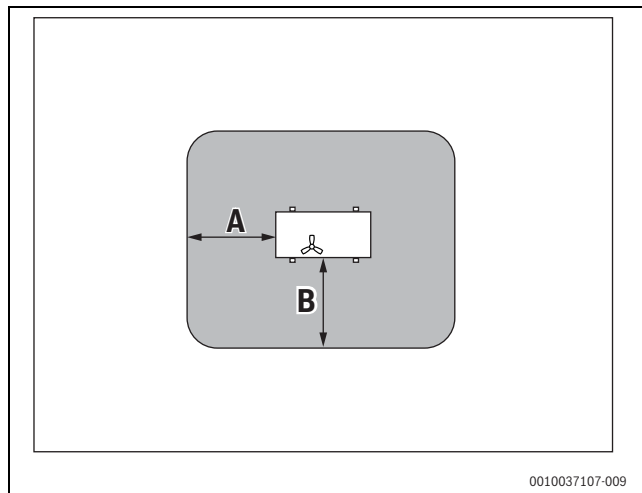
Zone de protection placée au sol sur un terrain ou sur un toit
